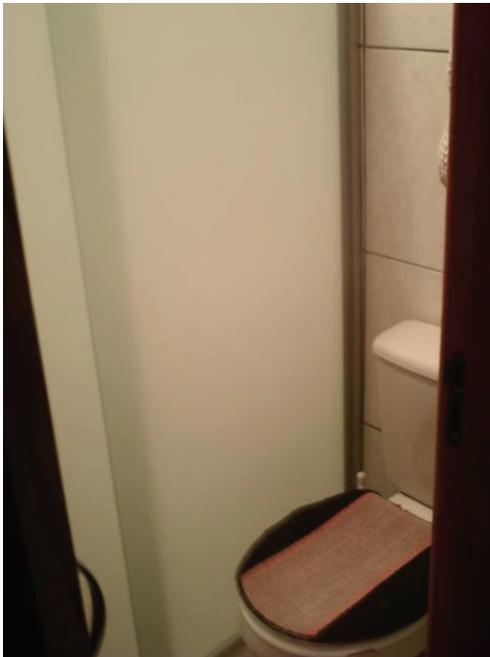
fotografia apartamento COHAB I. Artur Alvim- SP – banho.
